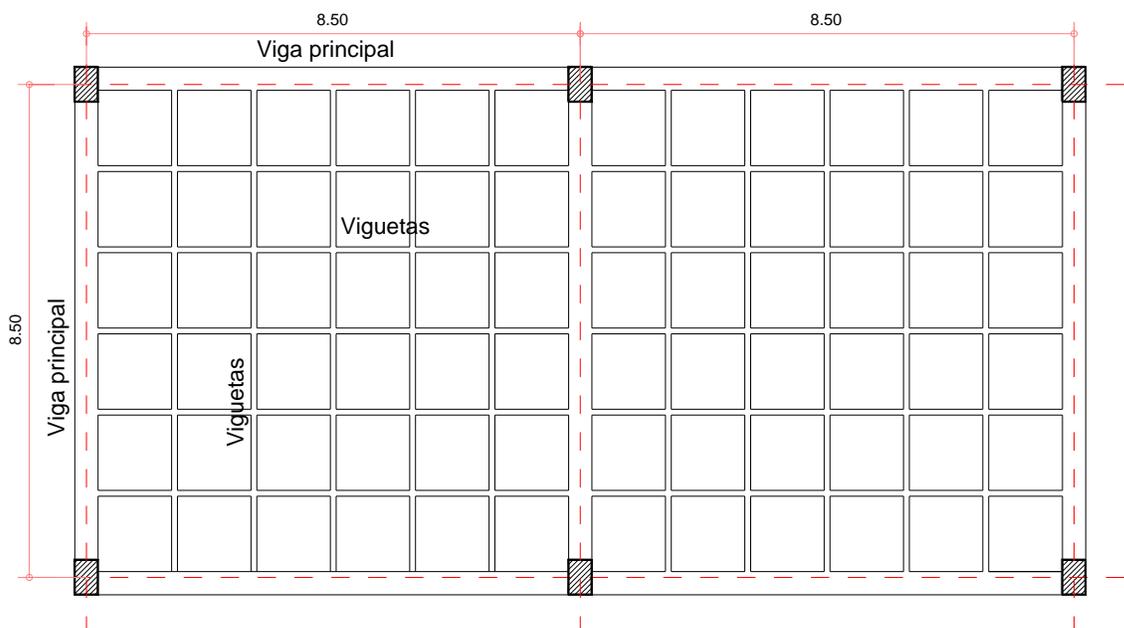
Esquema estructura en pórticos de concreto reforzado y losa aligerada armada en dos direcciones
